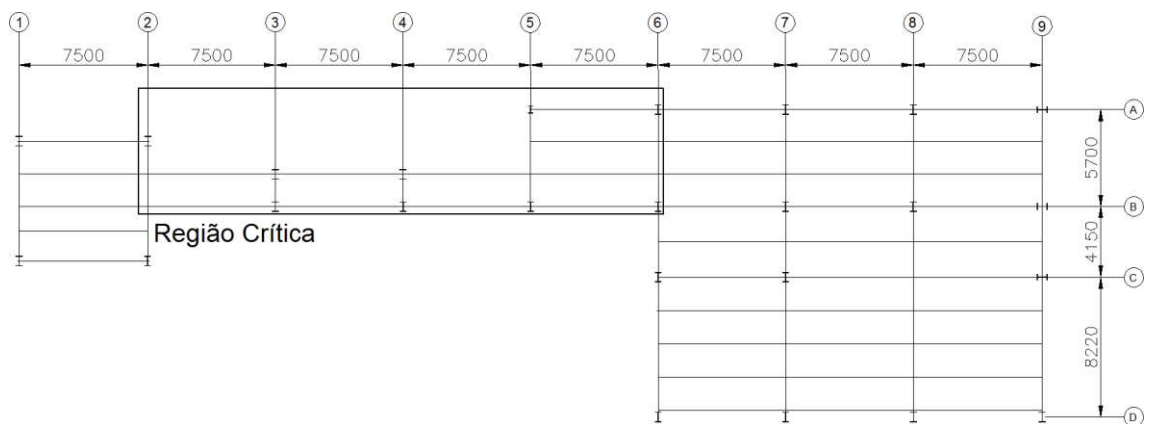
Plano das vigas do terceiro pavimento (EL. + 6200) do Laticínios FUNARBE.
